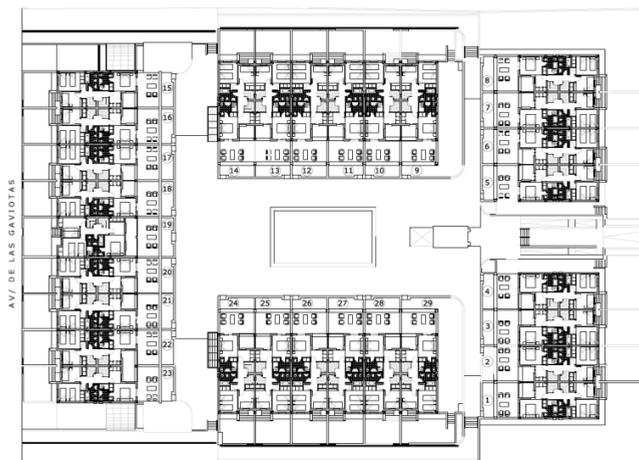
Distribución general planta primera. P. Ejecución 2006
